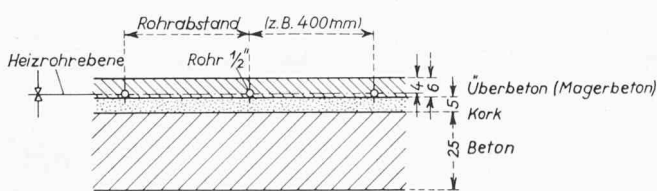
Querschnitt durch einen Betonboden mit einbetonierter Bodenheizung System Crittal
